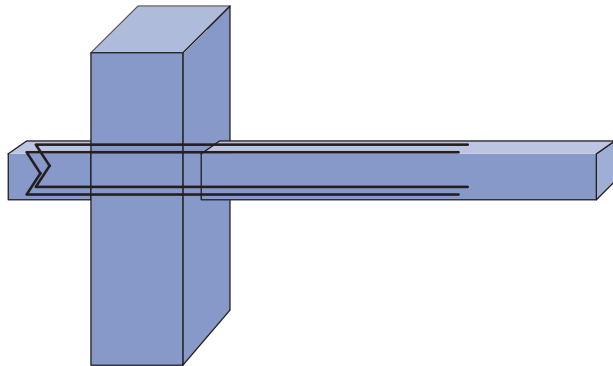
Ergot extérieur au nœud poutre-poteau
